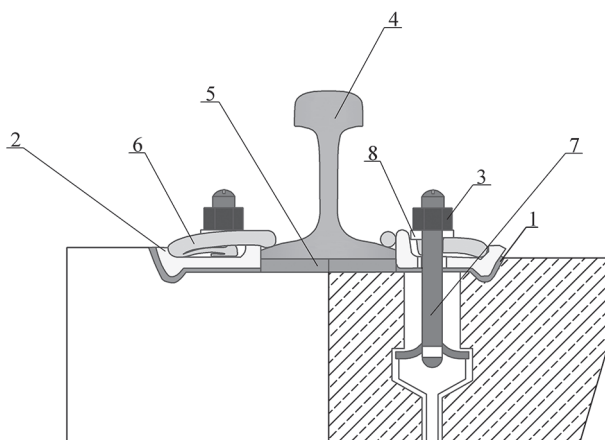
Рельсовое промежуточное крепление ЖБР 65: 1 — прокладка упругая; 2 — скоба упорная; 3 — гайка закладного болта; 4 — рельс; 5 — прокладка ЖБР; 6 — клемма пружинная ЖБР-3; 7 — закладной болт; 8 — скоба
